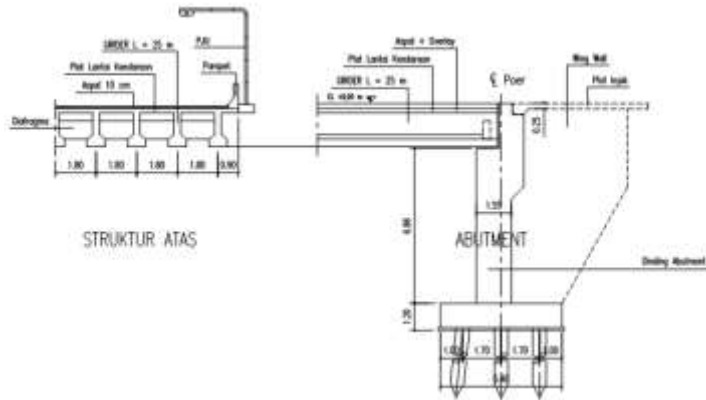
1 Perencanaan Abutment A2 (Sisi Surabaya)
